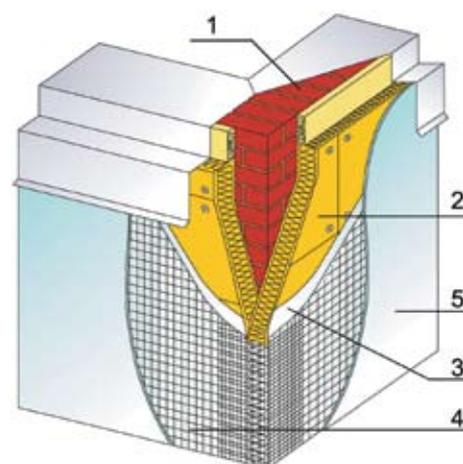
Внешний угол здания, утепленный плитами ИЗОФАС, в конструкции с тонкослойным штукатурным покрытием: 1. Несущая стена; 2. Теплоизоляционные плиты ИЗОФАС-140, ИЗОФАС; 3. Внутренний штукатурный слой; 4. Армирующий слой; 5. Внешний штукатурный слой
